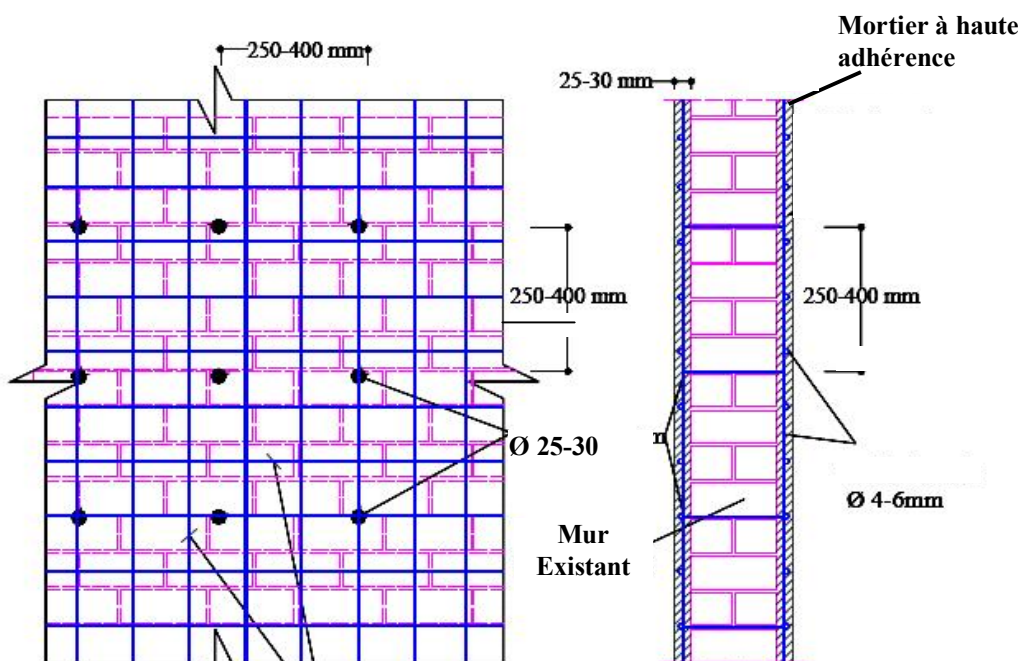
Renforcement d'un mur par des grilles métalliques
